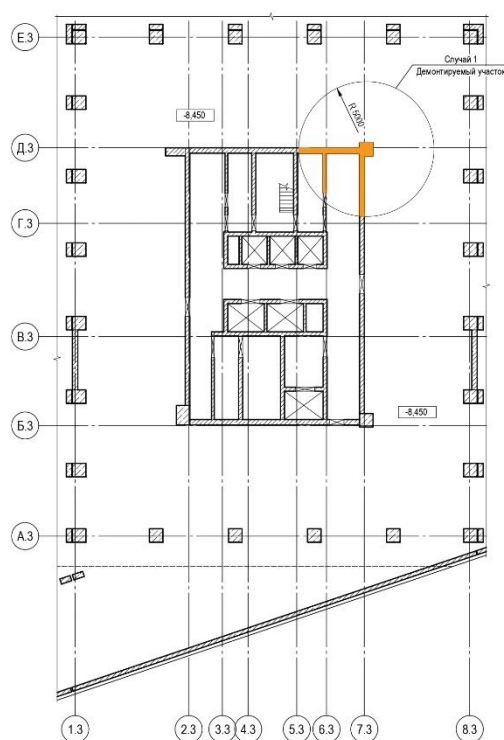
Корпус К-3. Схема аварийного случая 1
